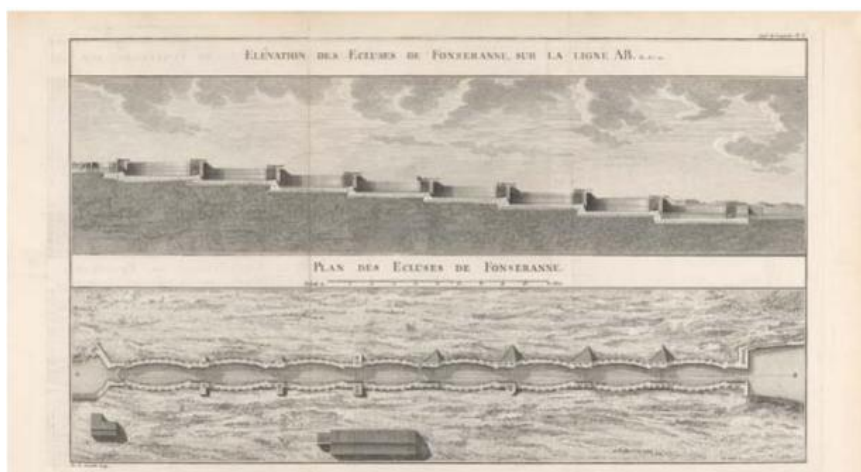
Planta y alzado de las esclusas de Fonserancs, en Jérôme de La Lande "Des canaux de navigation et specialement du canal de Languedoc". París 1778. Biblioteca Nacional de España.
